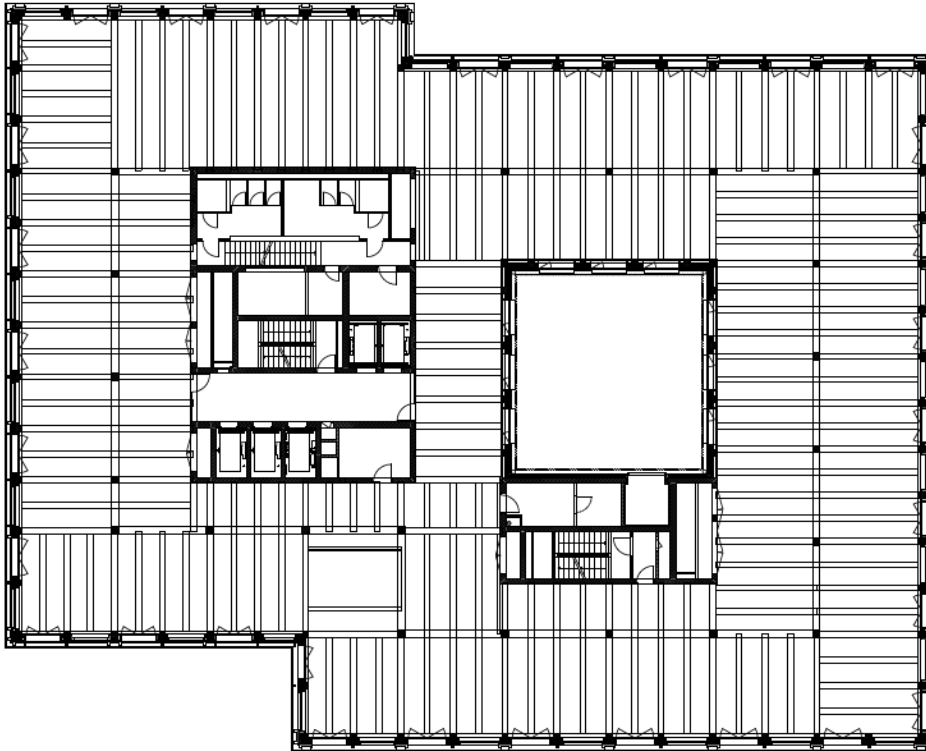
Grundriss 1.-5. Obergeschoss mit aussteifenden Kernen (Bildquelle: Burkard Meyer Architekten)
